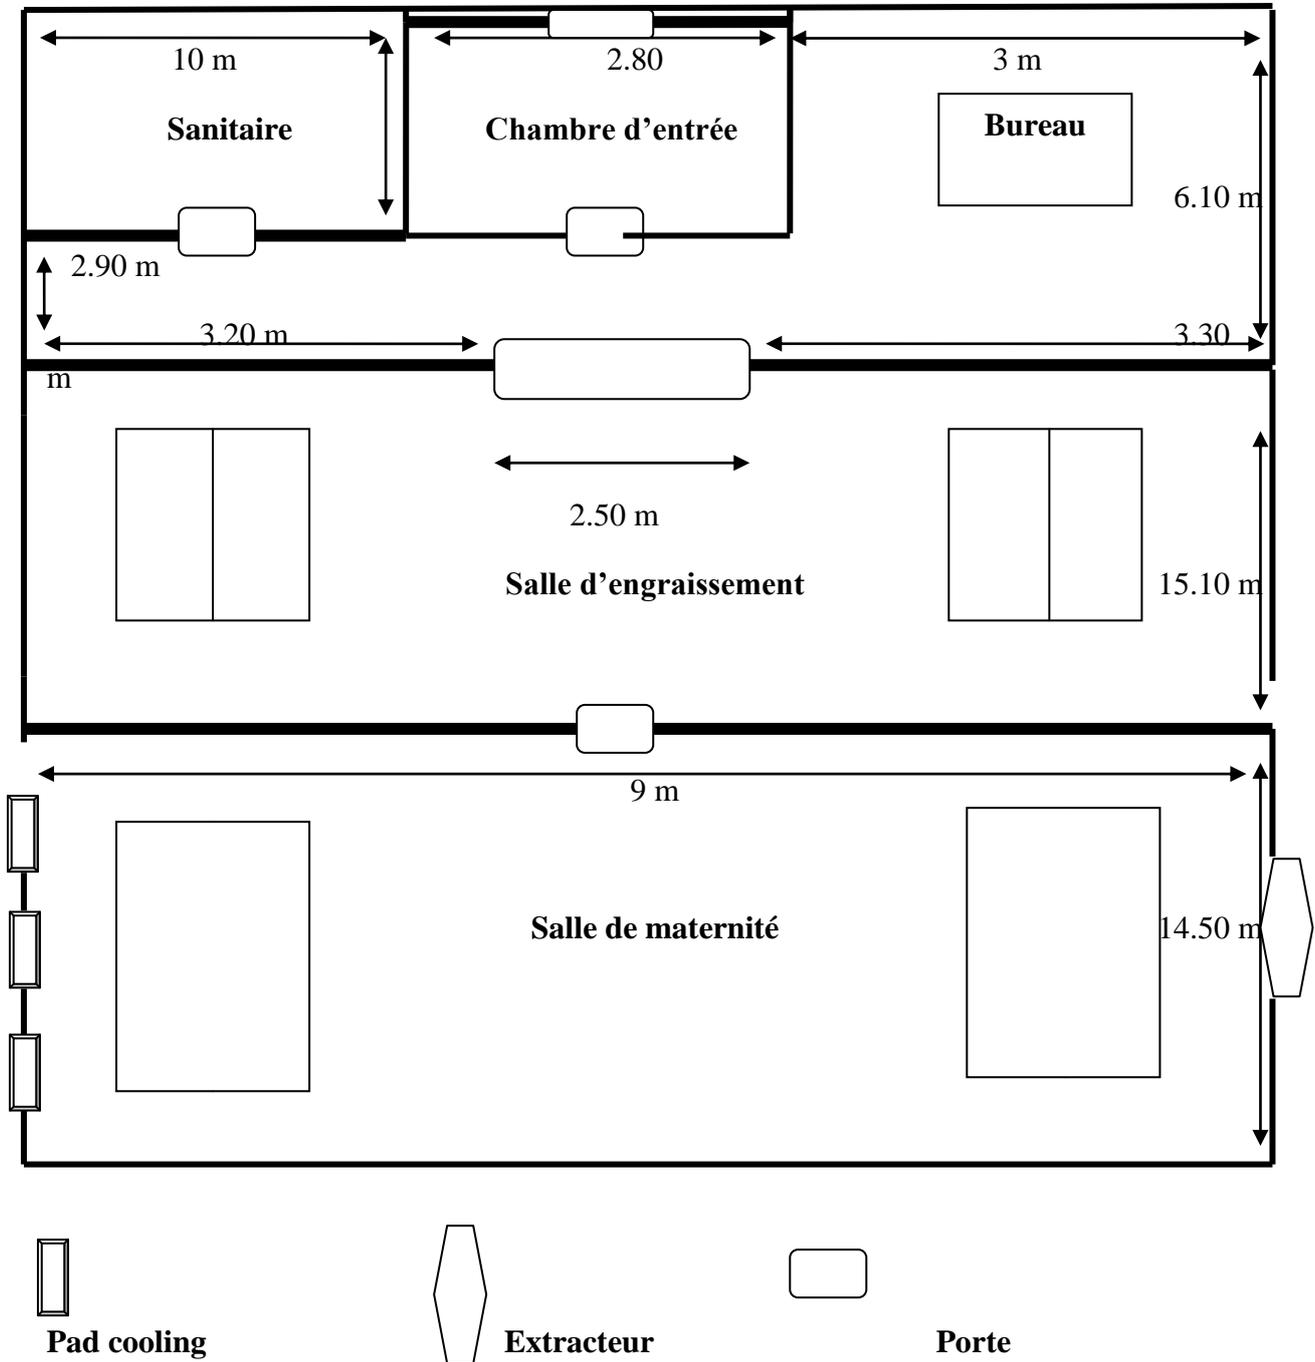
Plan général du bâtiment (clapier de ITELV, BabaAli)
